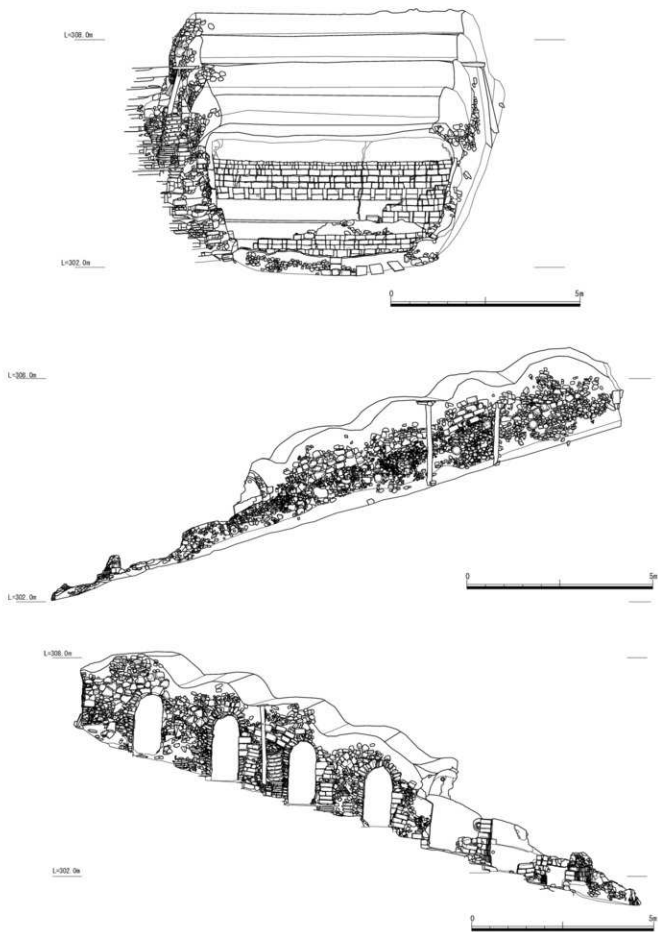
22-10次 立面图(上段:前面,中段:右侧面,下段:左侧面)
